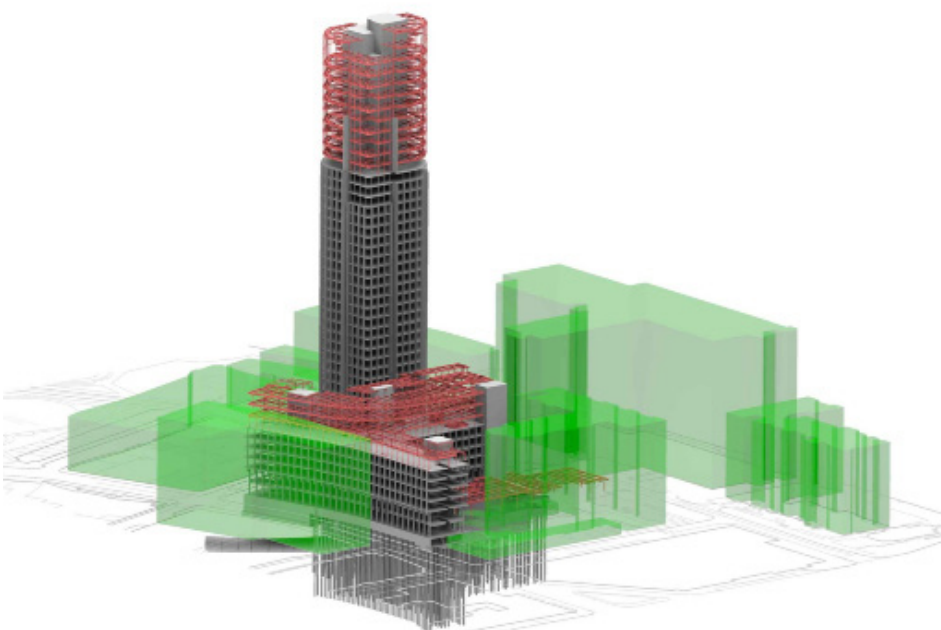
Modelo Estrutural do Edifício South Bank Tower
